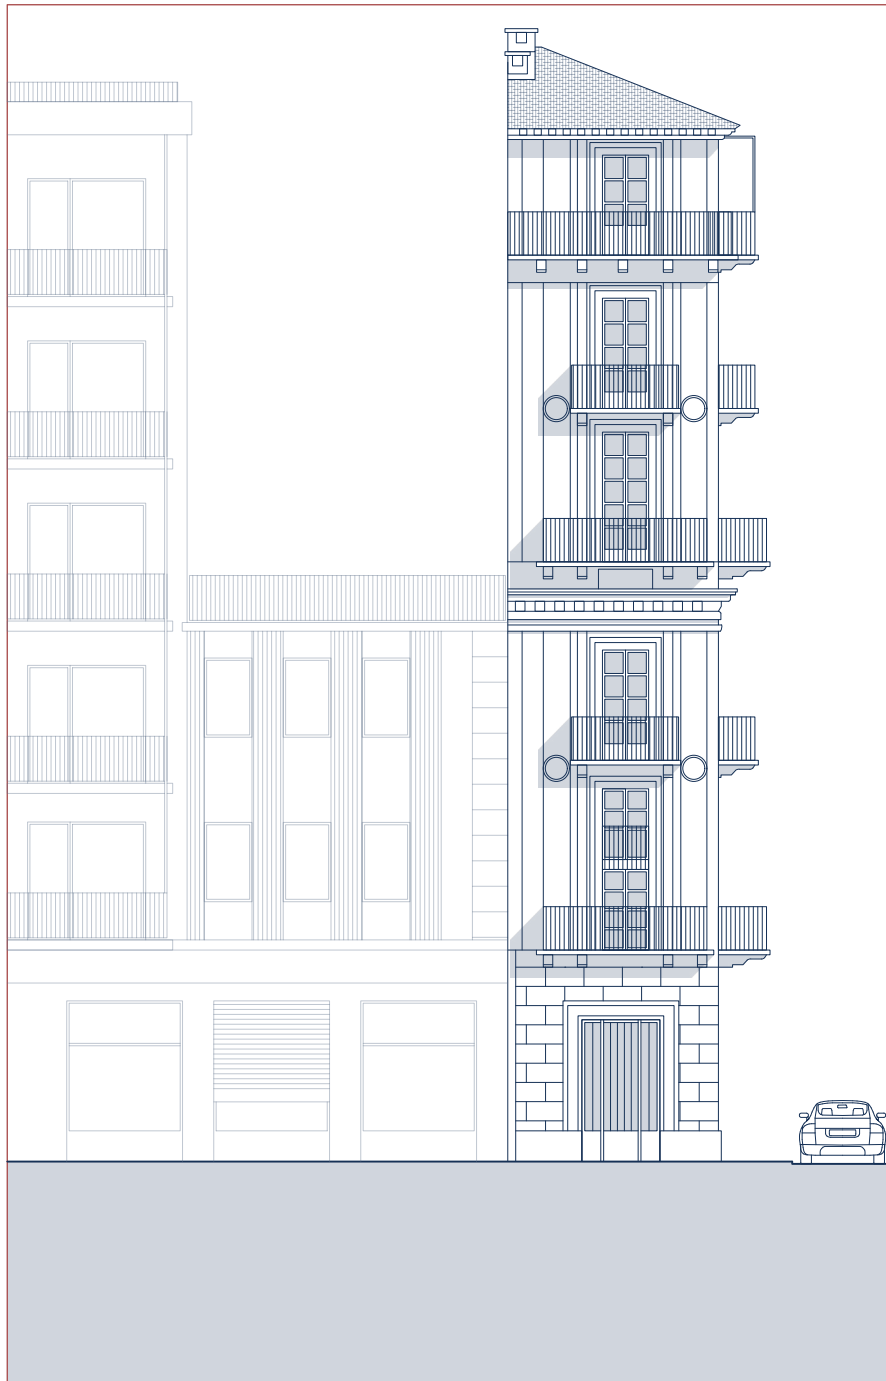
Prospetto su corso San Maurizio, rielaborazione propria
